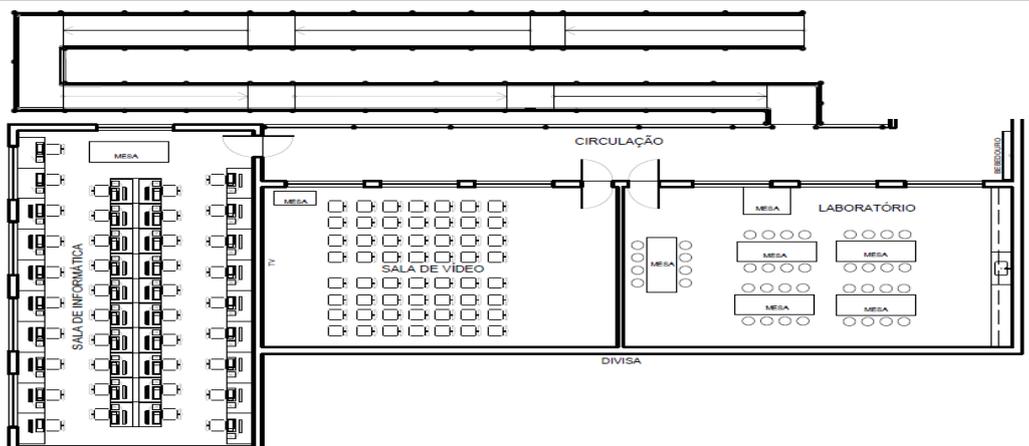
Planta baixa do segundo pavimento Anexo III da E.E. Doutor Arthur Bernardes.
